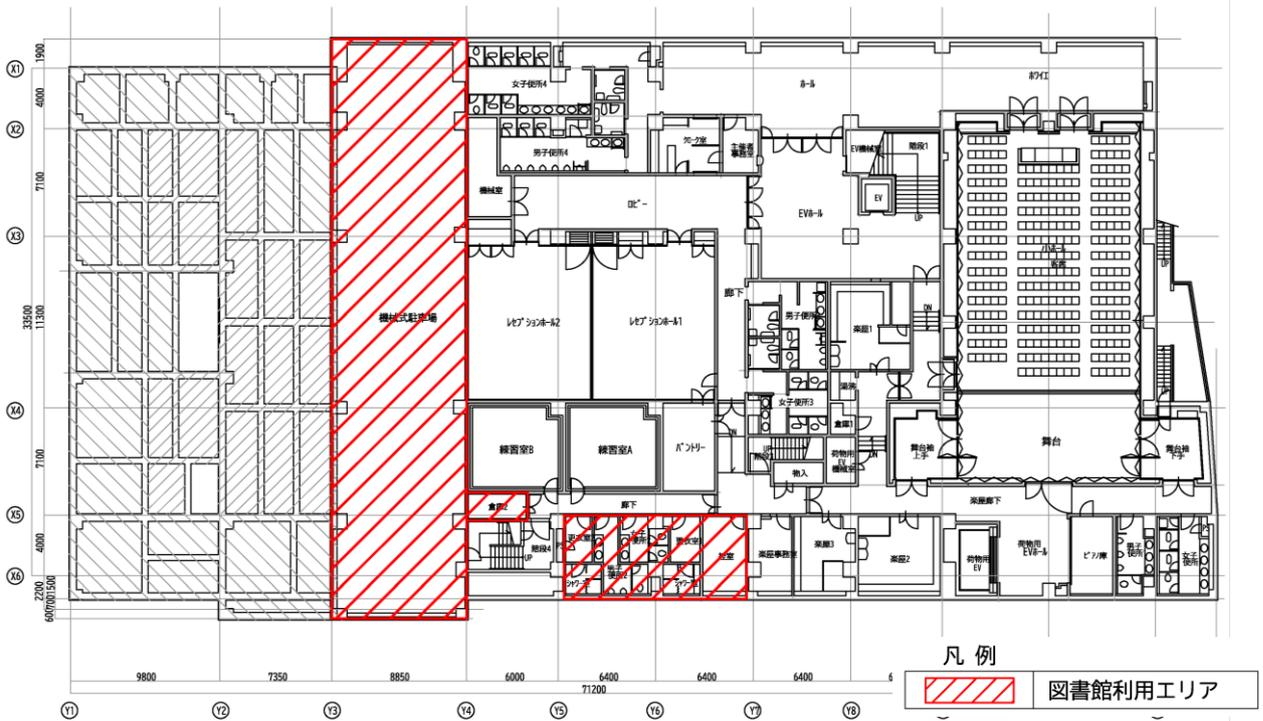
市民文化会館（リビエールホール）機能位置図（案） 地下1階平面図
